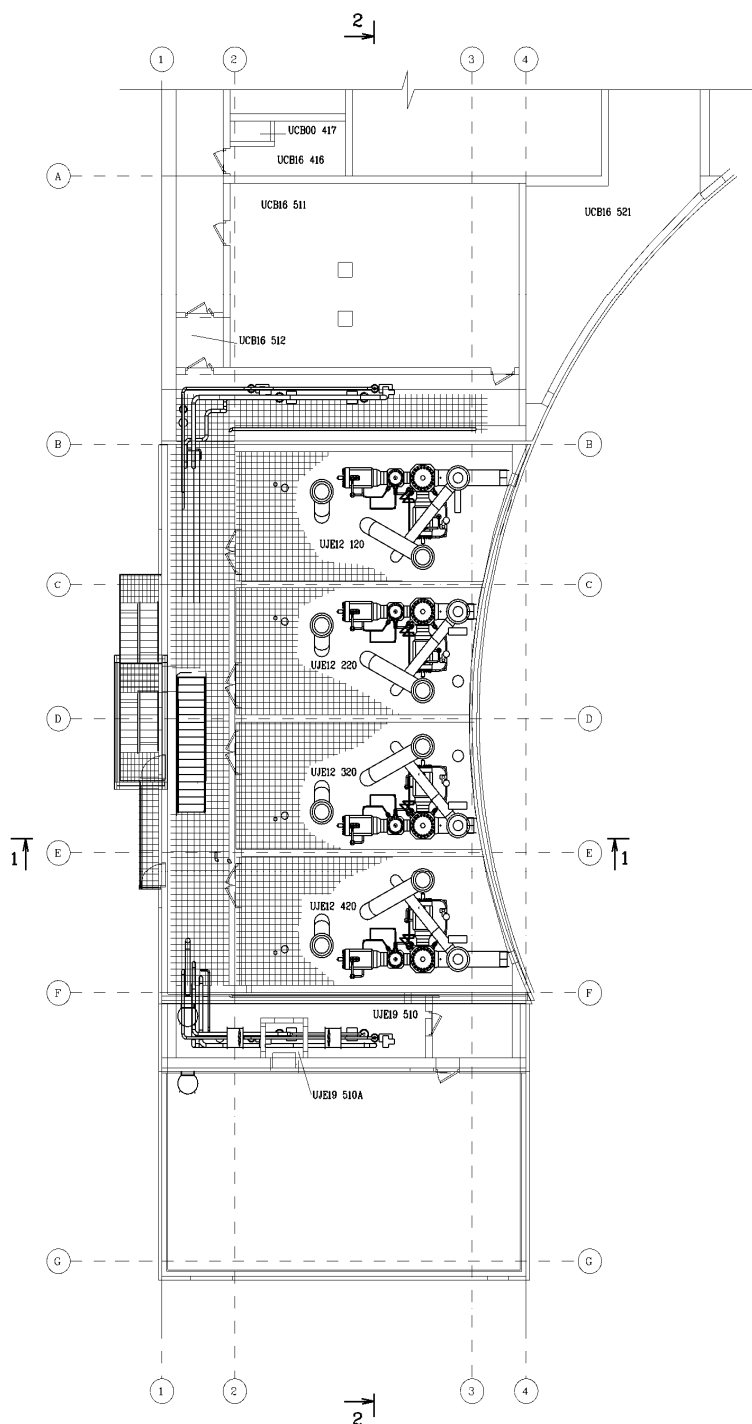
Компоновка помещений. План на отметке + 16,20
